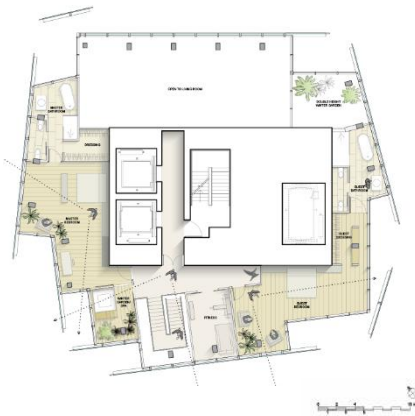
plan de 1<sup>er</sup> étage d'un appartement en duplex
